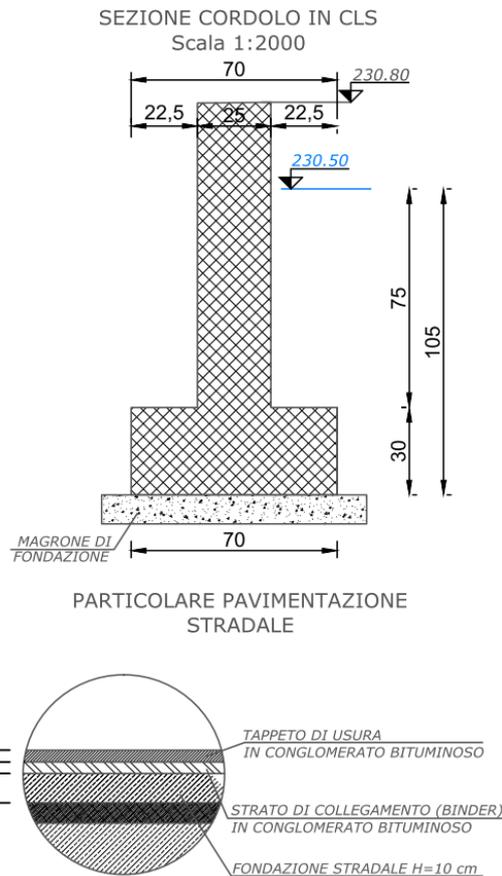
CORDOLO IN CALCESTRUZZO E RETE ELETTROSALDATA DI PROTEZIONE DEL RILEVATO SU CUI SORGERA' IL PIAZZALE DI SERVIZIO DELLA CENTRALE
